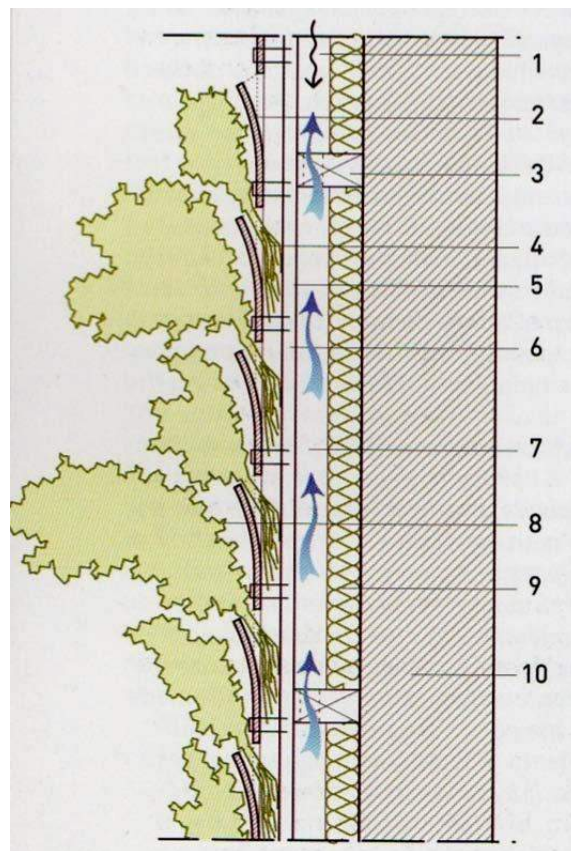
Corte explicativo de uma Parede Viva Hidrópica (retirado de: Garrido, 2011)
